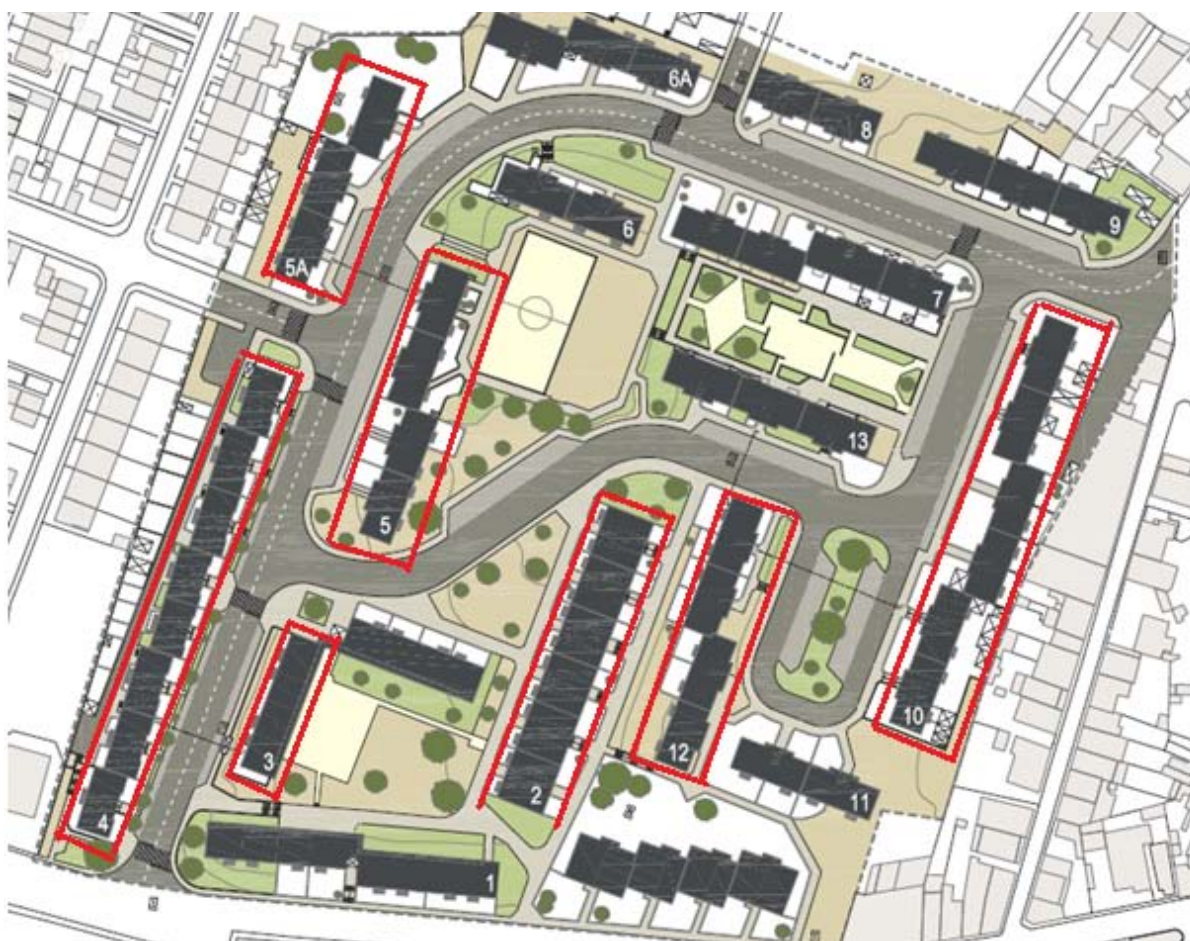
Planta do bairro de Contumil. Destaque para os blocos 2, 3, 4, 5, 5A, 10 e 12, assinalados a vermelho, com os seus topos orientados praticamente a Norte, ideais para a aplicação dos jardins verticais (Retirado de Pedrosa, 2010).
